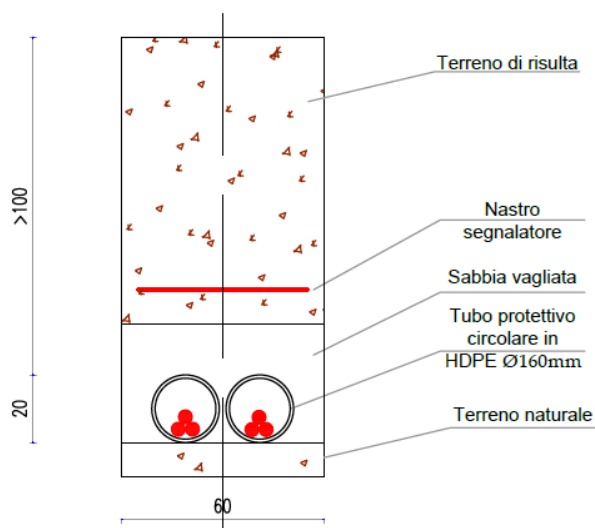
Sezione delle due terne MT in progetto per la connessione dell'impianto alla rete
